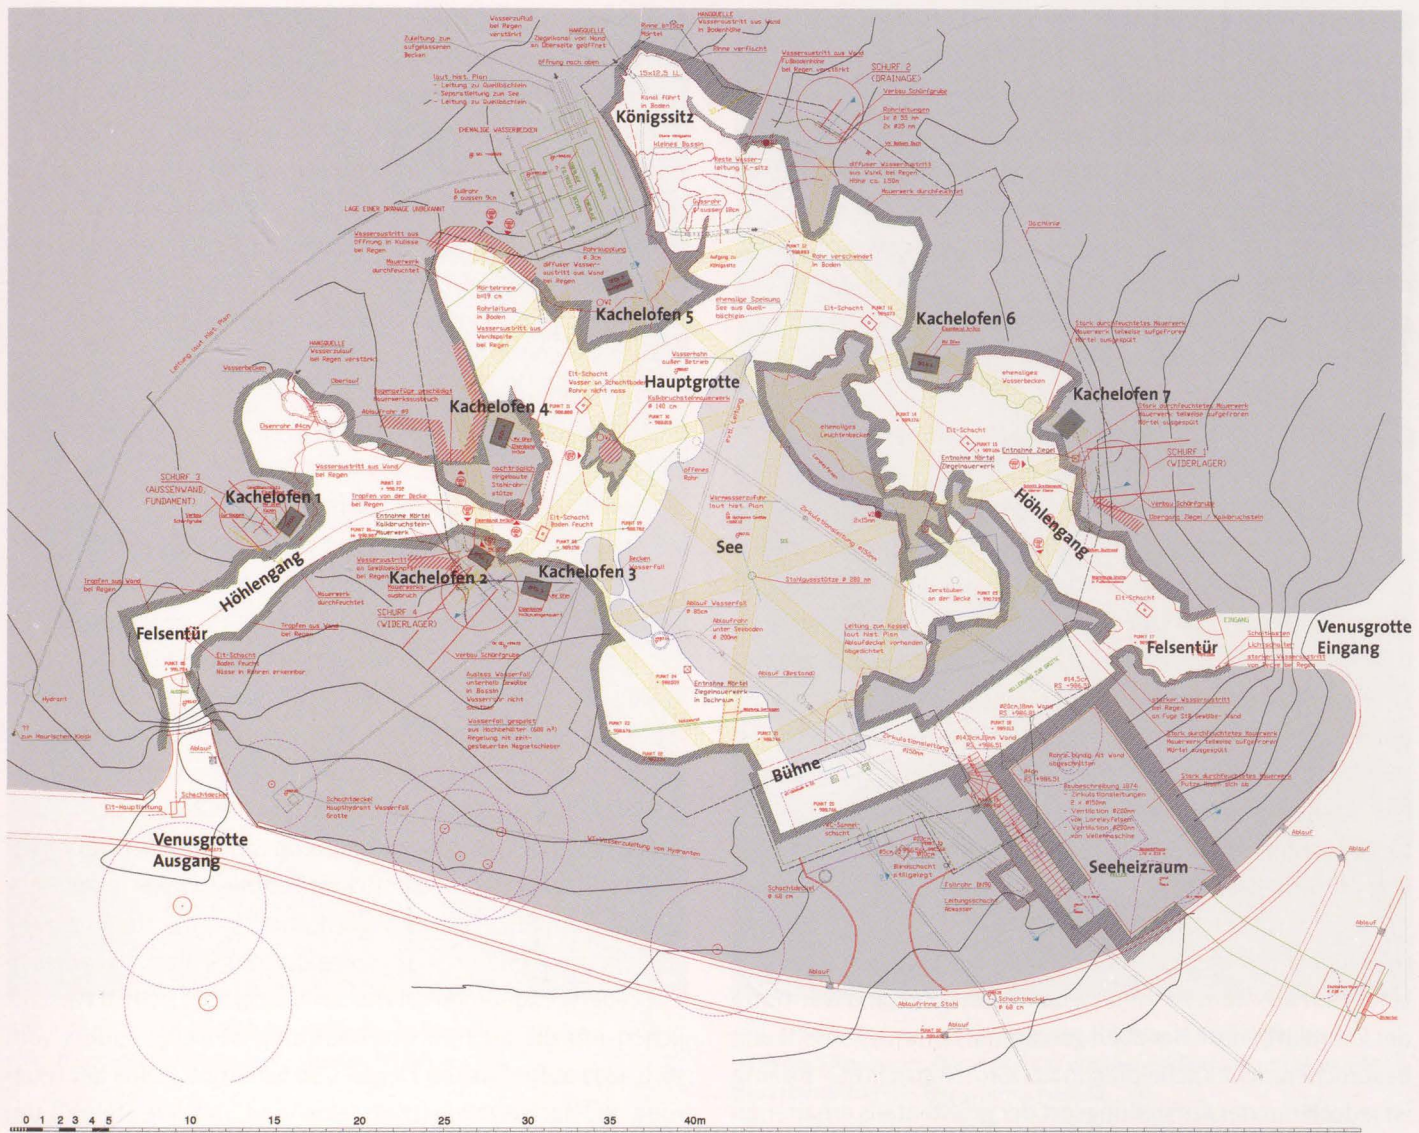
Schloss Linderhof, Venusgrotte, Grundriss mit Eintragung der erhaltenen Kachelöfen-Standorte
